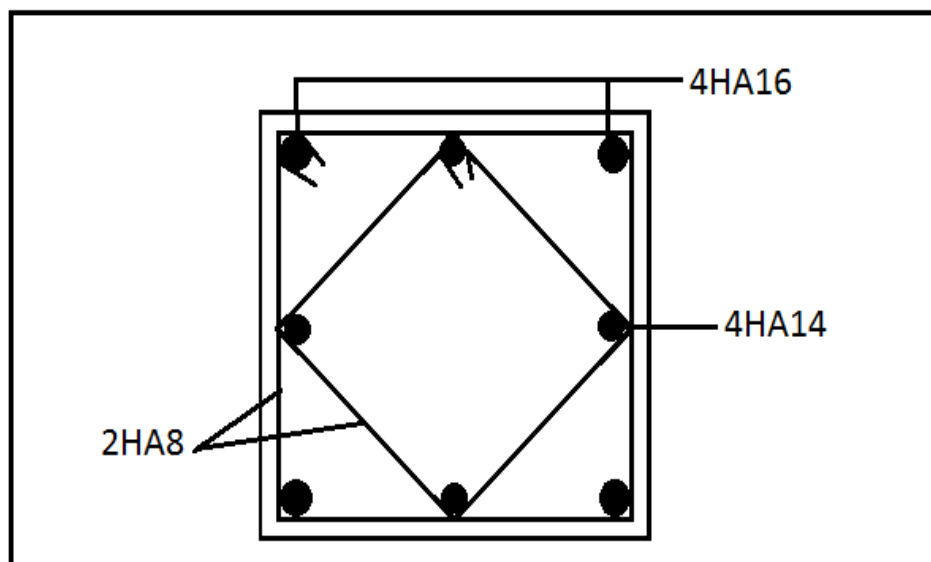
Ferrailage Poteau 40x40
